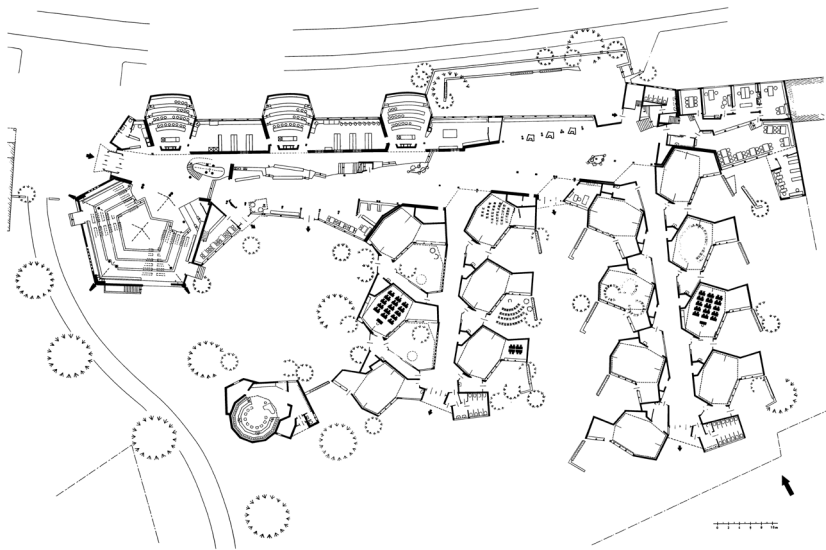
Grundriss Erdgeschoss der Geschwister Scholl-Gesamtschule in Lünen (Spital-Frenking & Ewers 2014, 7)
